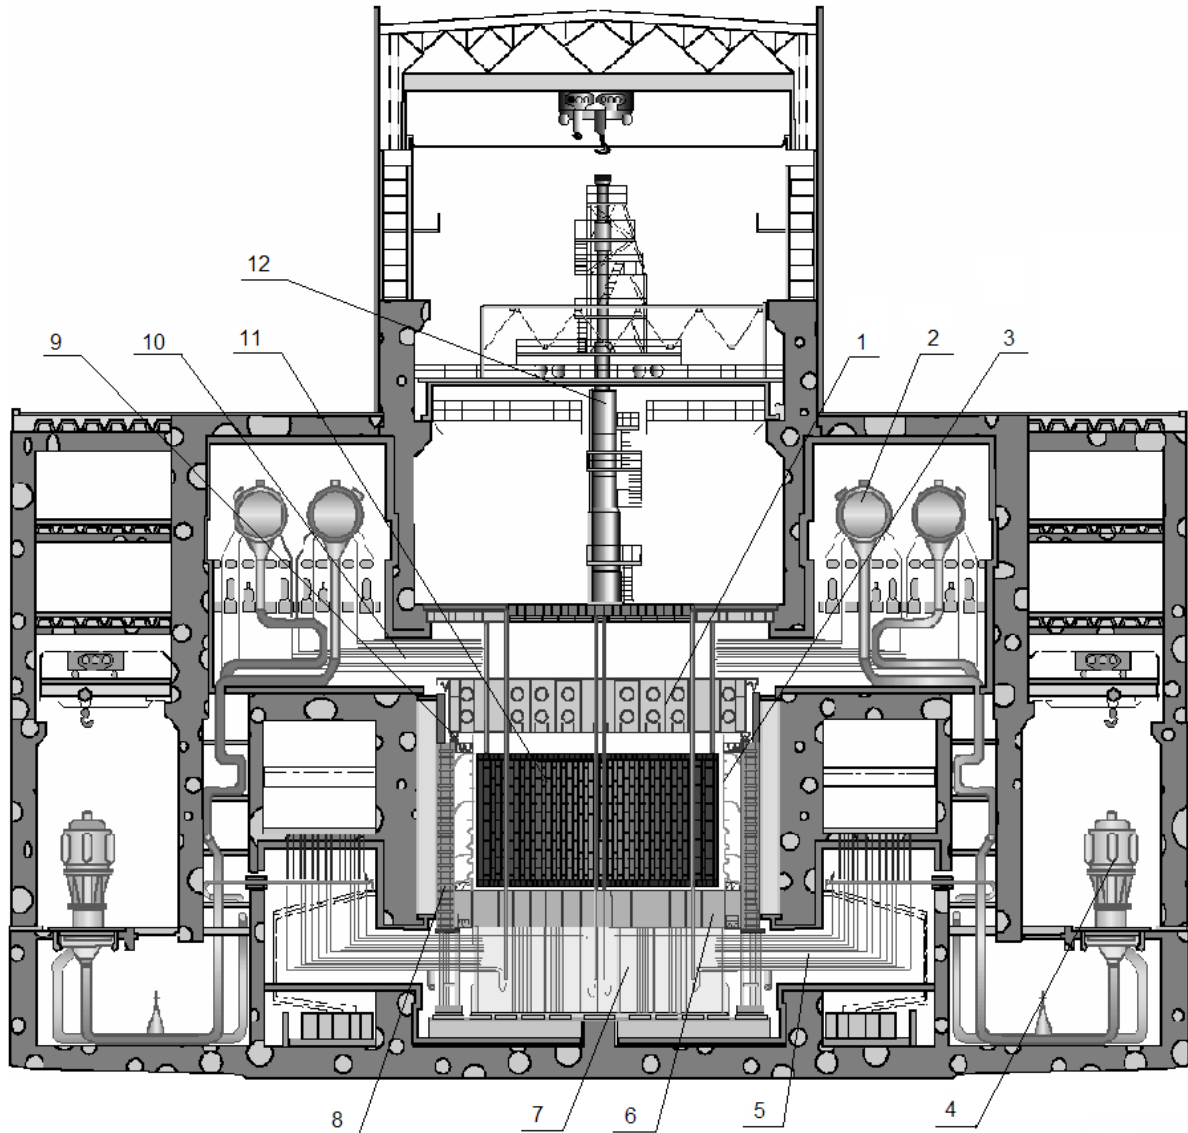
Общий вид реакторной установки с реактором РБМК:
